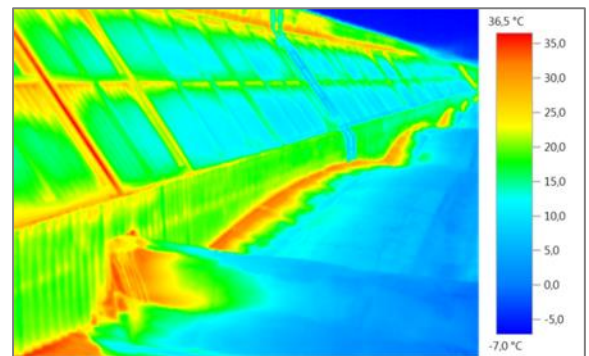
Теплопотери через стык кровли со стенами Термограмма утепленного и
